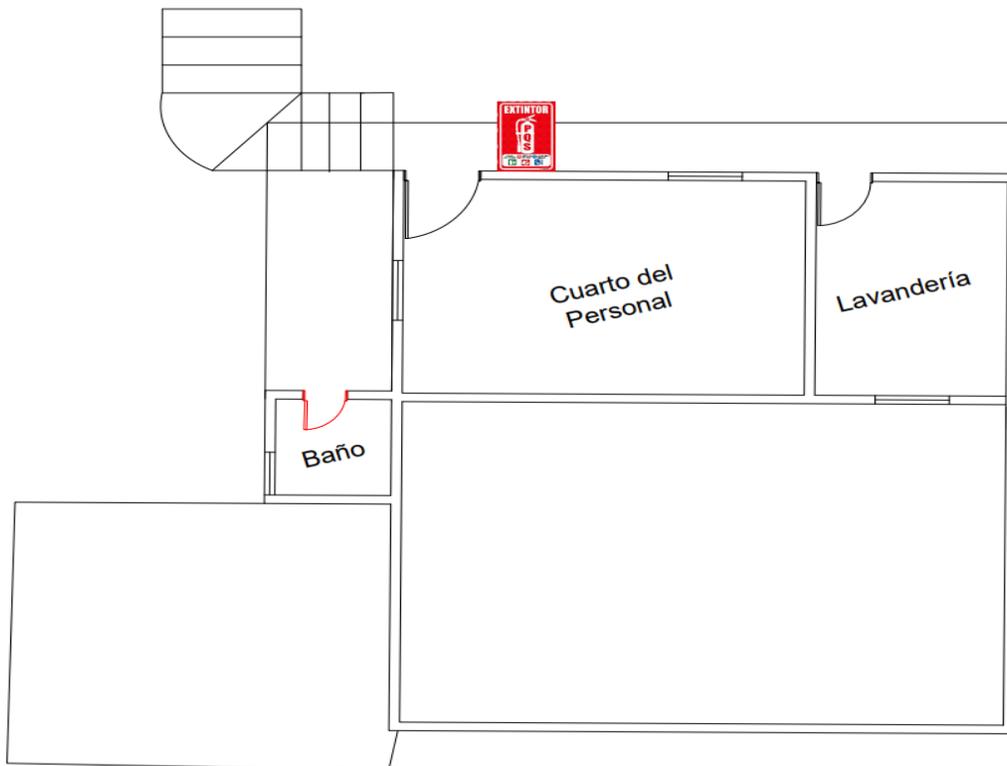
Ubicación de extintor en oficinas y cuarto de trabajadores planta baja
